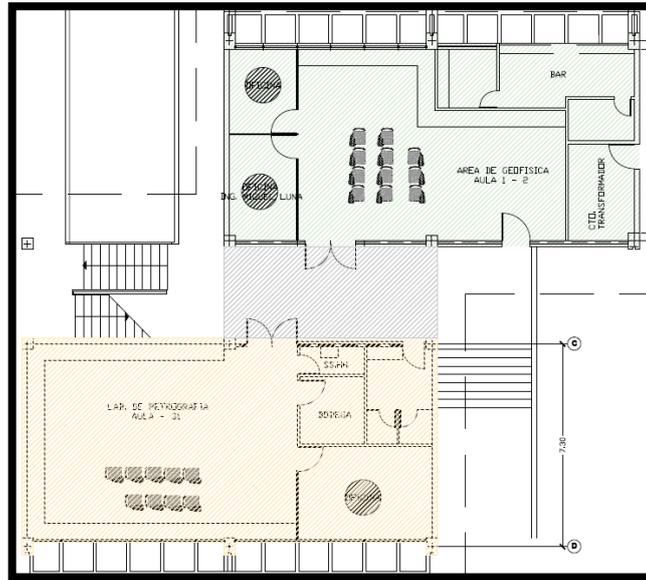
Planos, planta baja, Edificio 20-A, Zona 1
